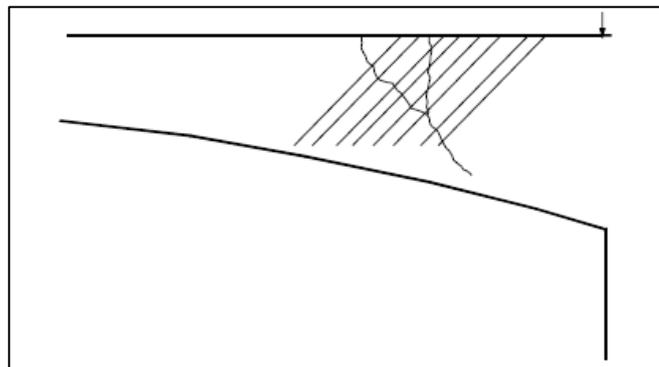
Orientación de las barras de armadura utilizadas para reparar fisuras (Stratton et al., 1978)
